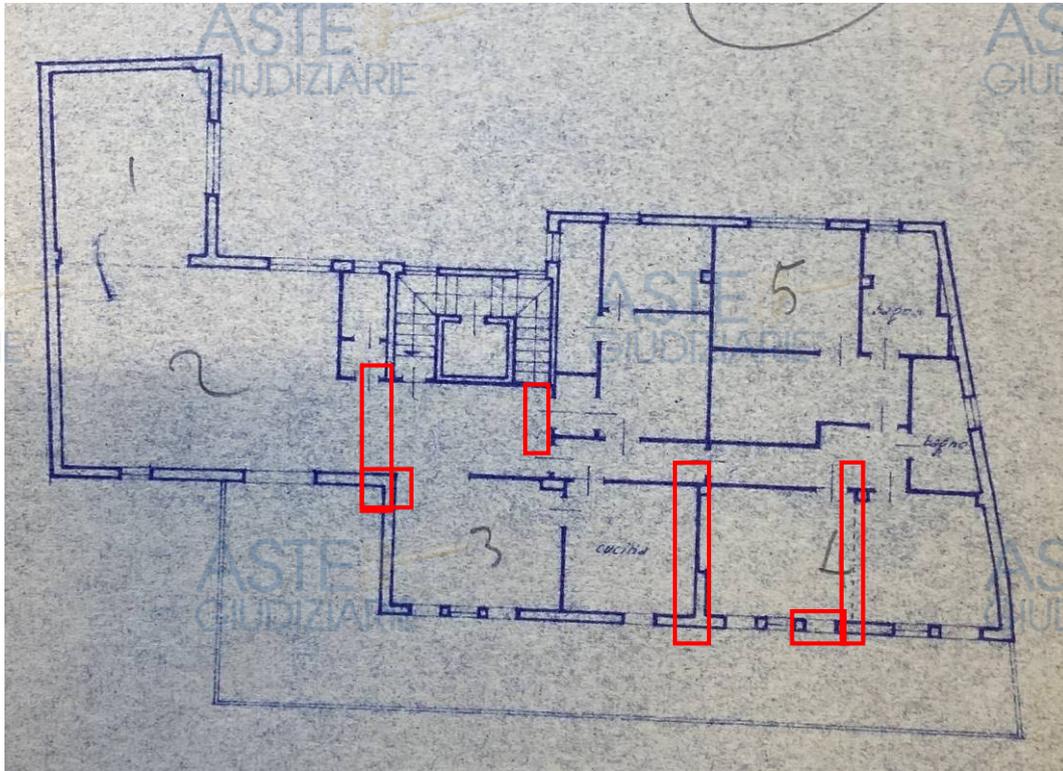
Estratto pianta di progetto di variante Prot. Gen. 13711/1967 Prot. U.T. 2161 del 17.05.1967 -Piano attico
